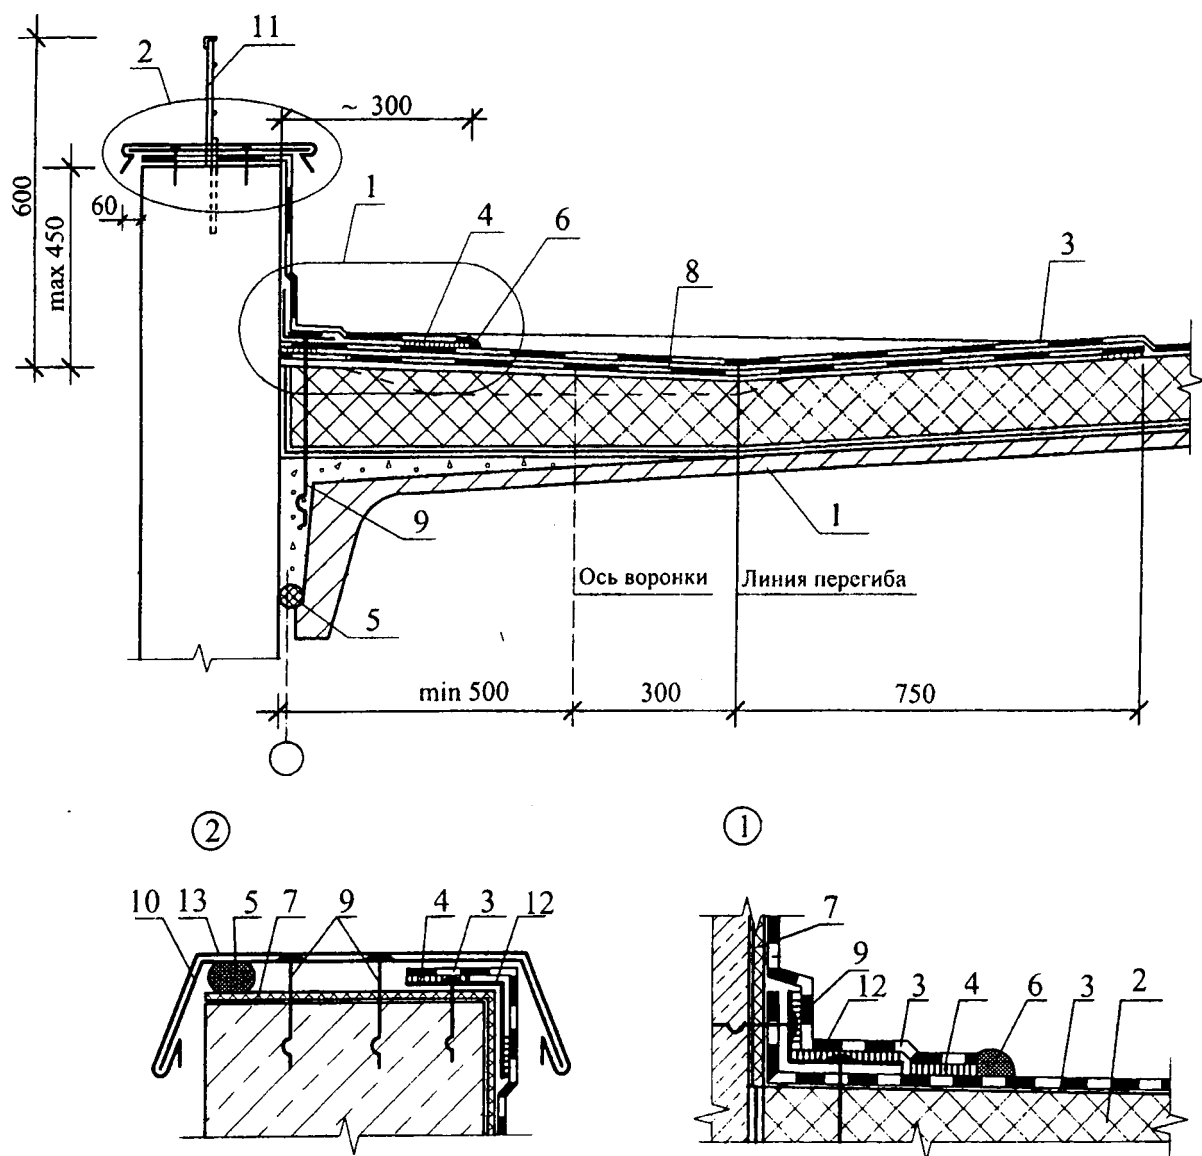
Узел примыкания мембранной кровли к парапету высотой не более 450 мм:
